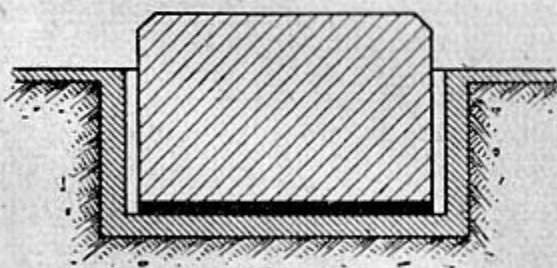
Mit eisenarmiertem Naturkork isoliertes Fundament. K 1102
